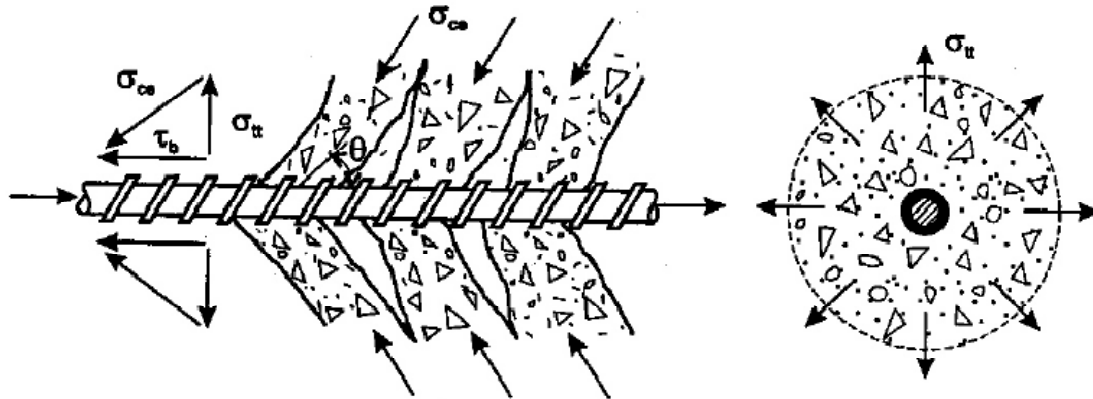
Fissuração do concreto no entorno das barras (FUSCO, 1994)
